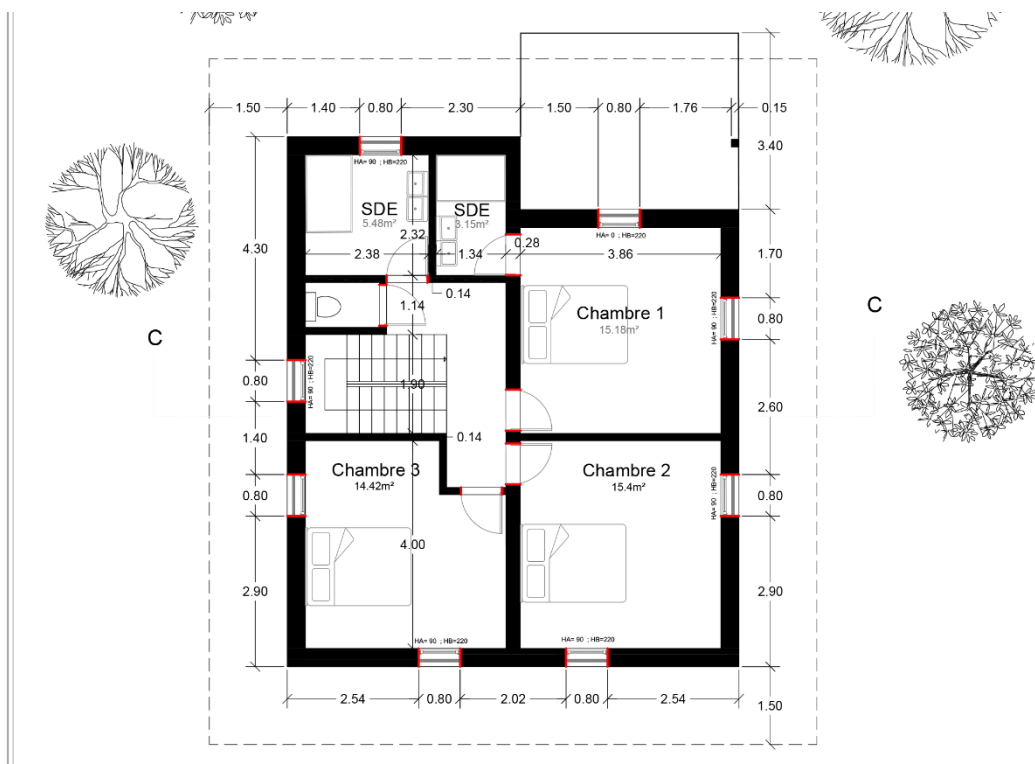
Plan du R+1 avec joint de dilatation de l'Archétype 3
